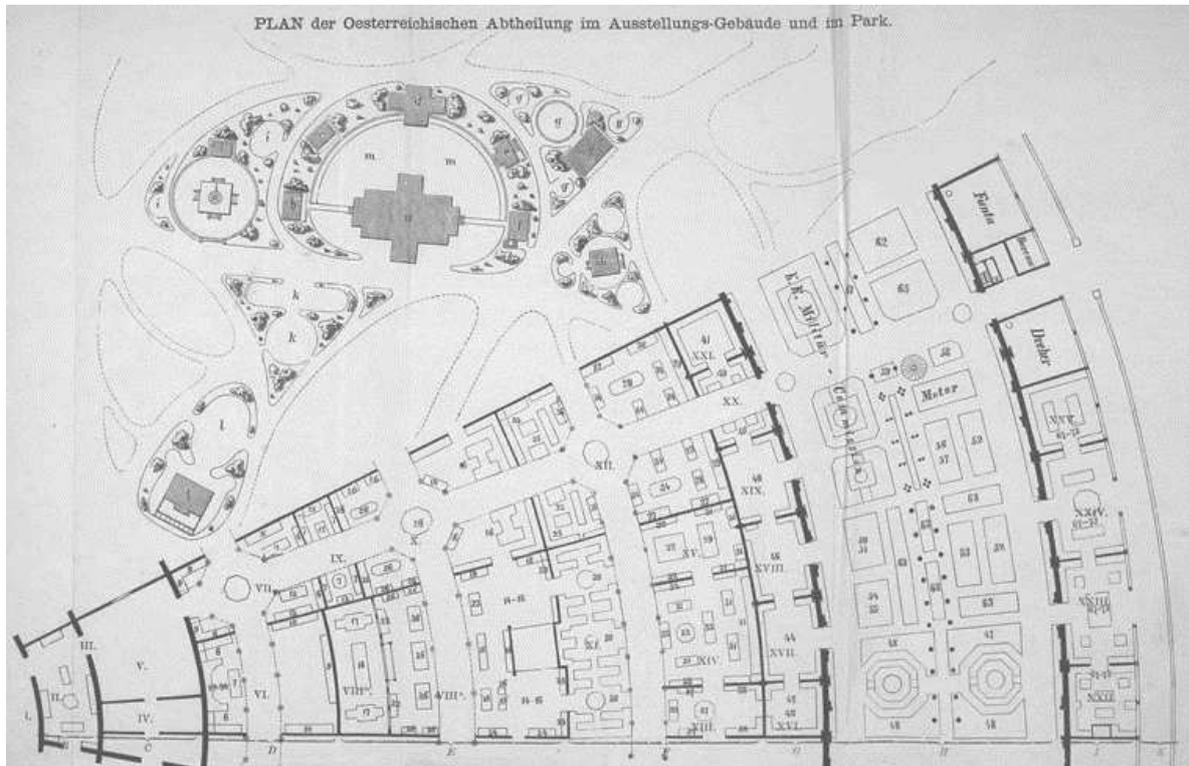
Österreichische Abteilung im Ausstellungsgebäude und Park, Grundriss, Paris, 1867
